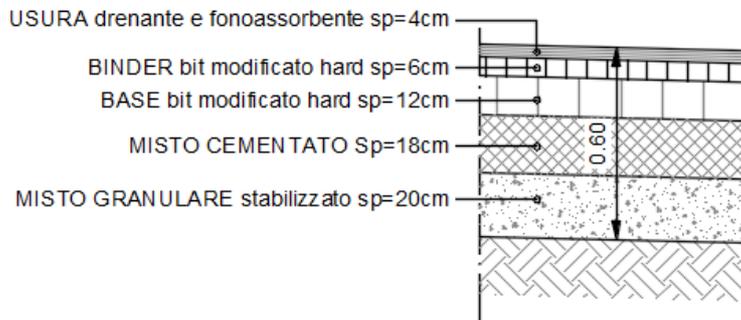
Pacchetto pavimentazione "Pedemontana Piemontese"
